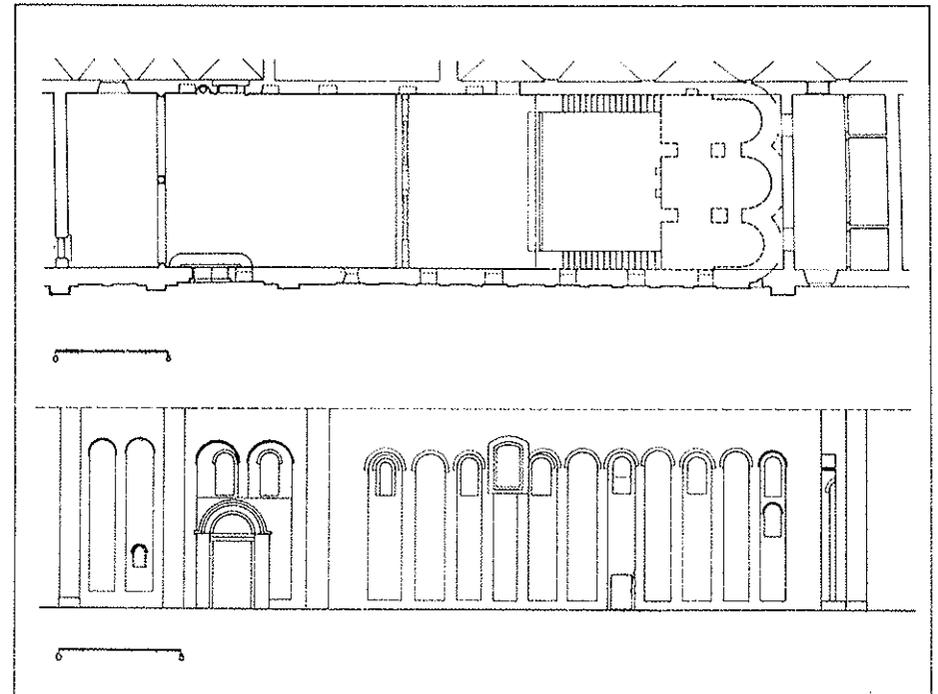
Pavia, S. Felice: planimetria e alzato del muro meridionale
